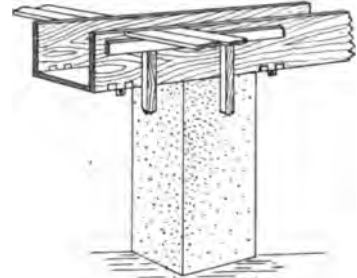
Balkenverschalung mit Hilfe der „Dielhalter“.
